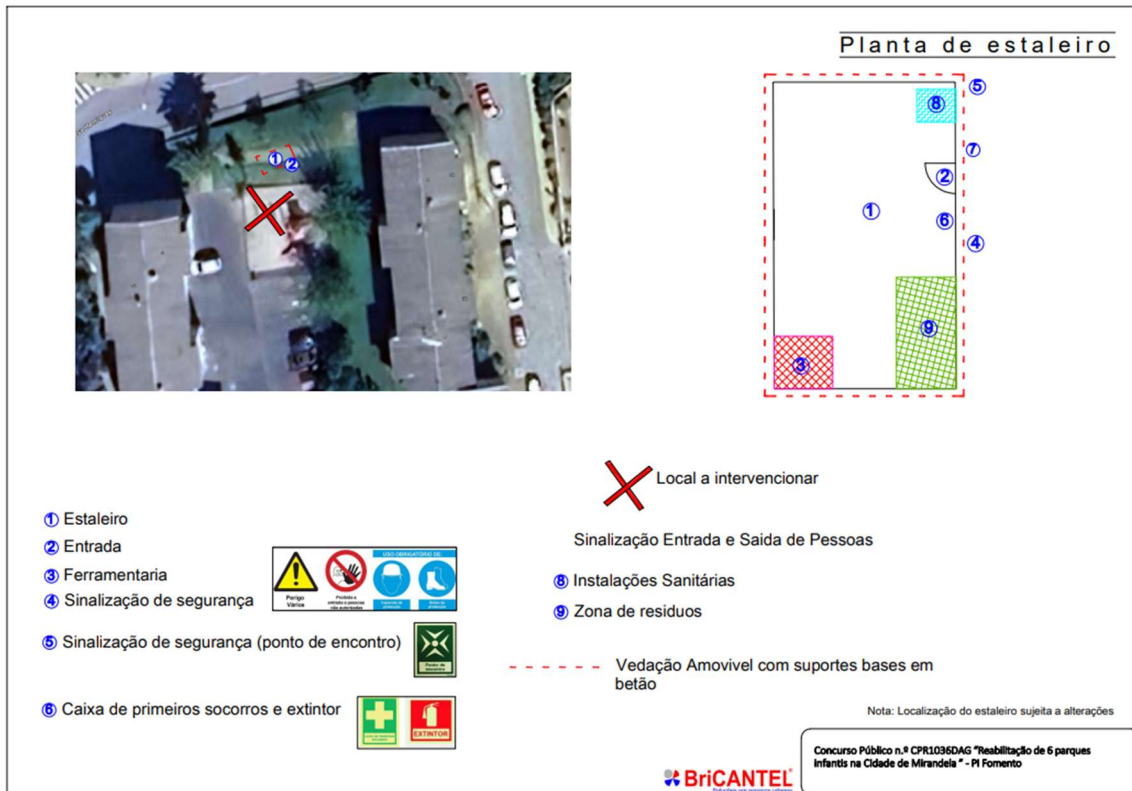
Planta de Estaleiro Parque Infantil de Formento, Mirandela
